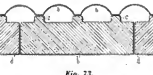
Wassermammelreservoir in Cementkalkconstruction.
